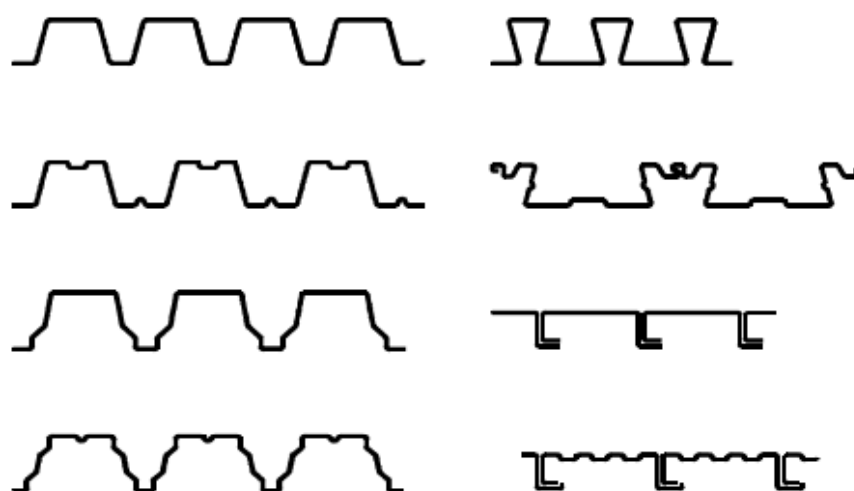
Tipos de chapas perfiladas enformadas a frio [4]
